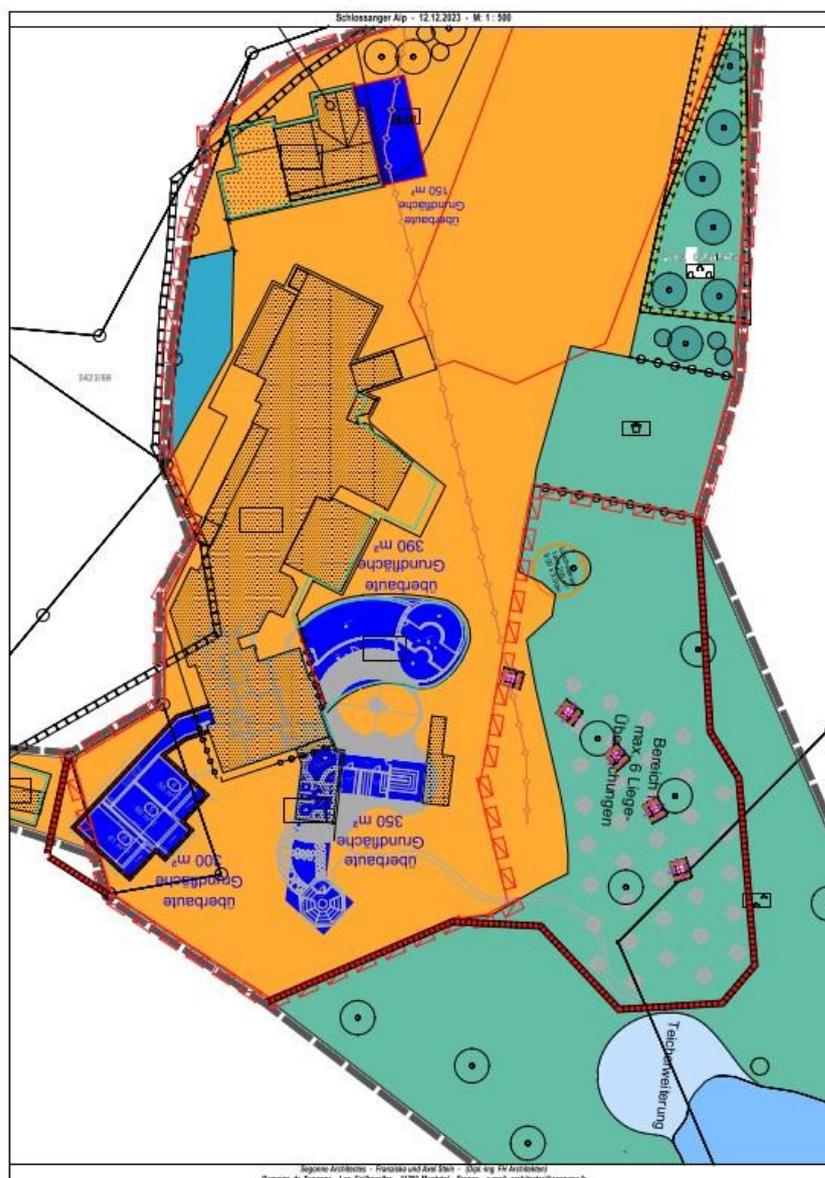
Planungsalternative mit Erdkörben und Liegebereichen östlich der Bestandsgebäude
